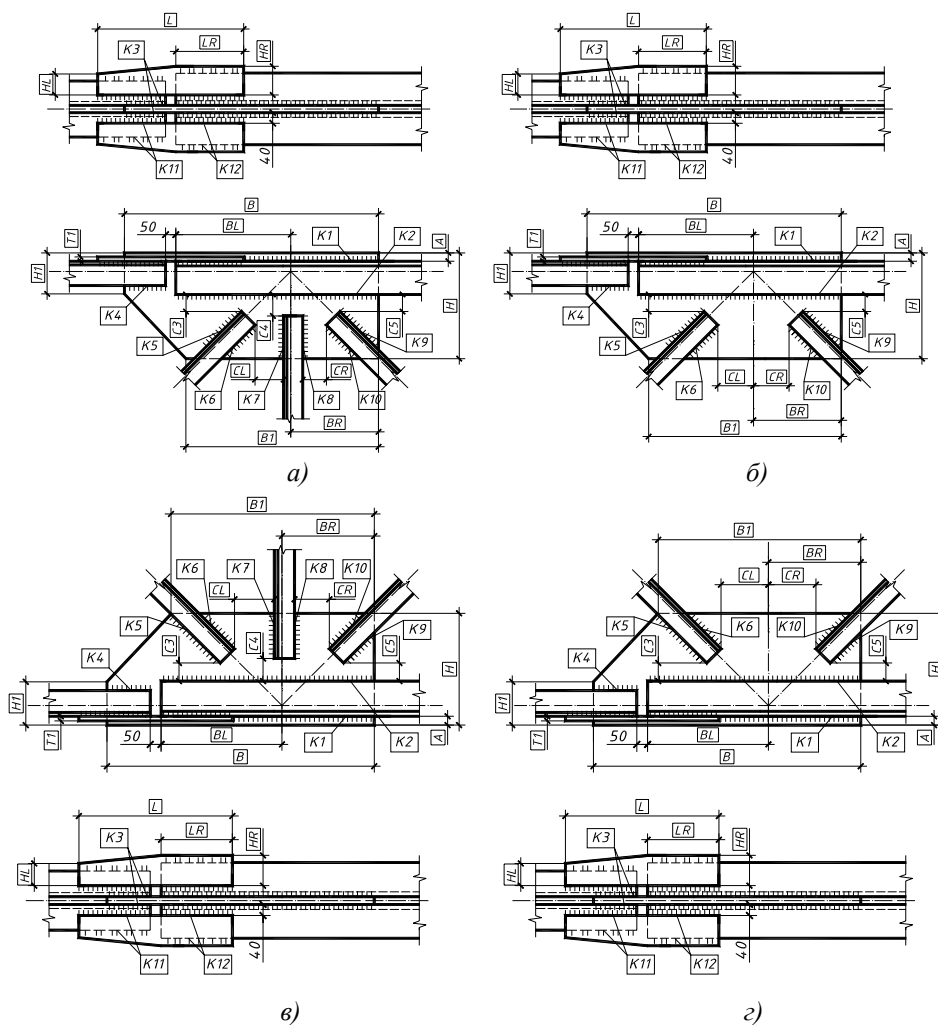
Узлы смены сечения пояса по длине в фермах из спаренных уголков
